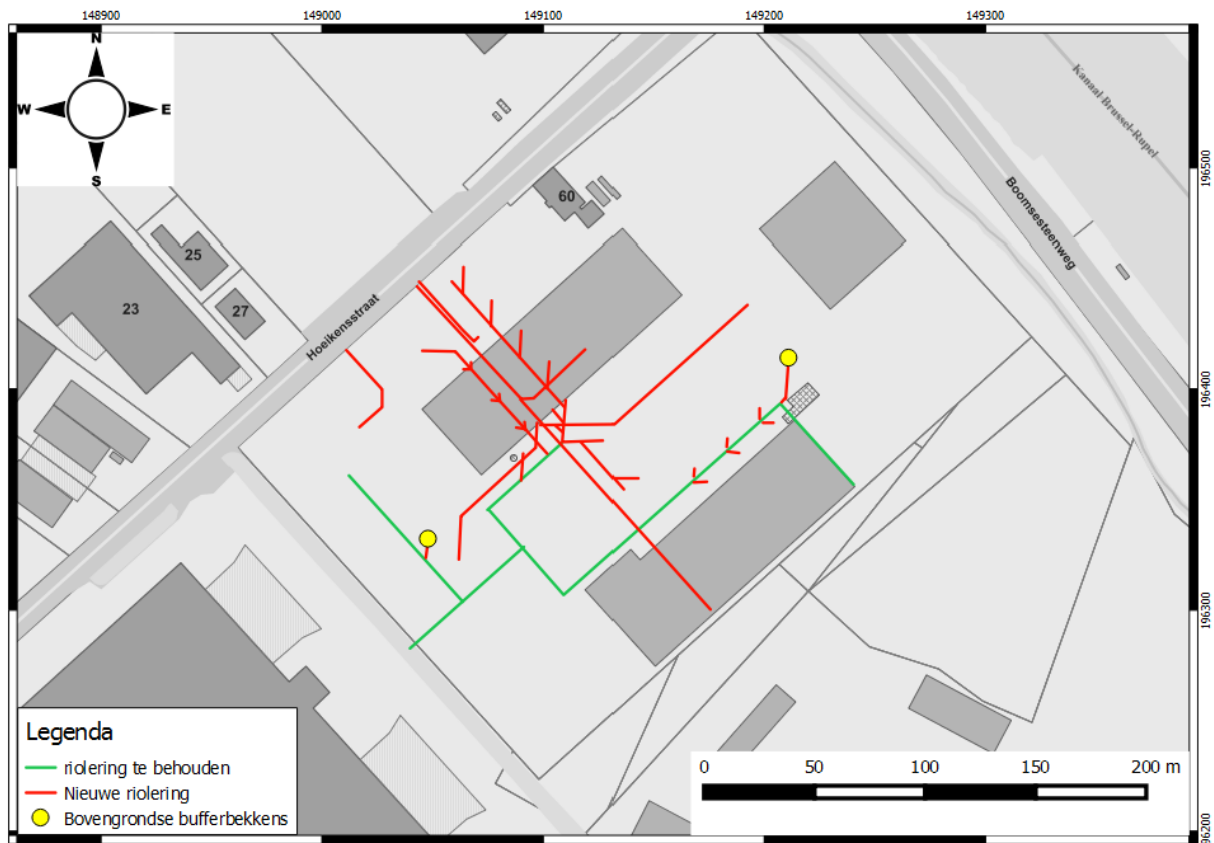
Inplantingsplan betoncentrale (bron: Opdrachtgever 2017).
